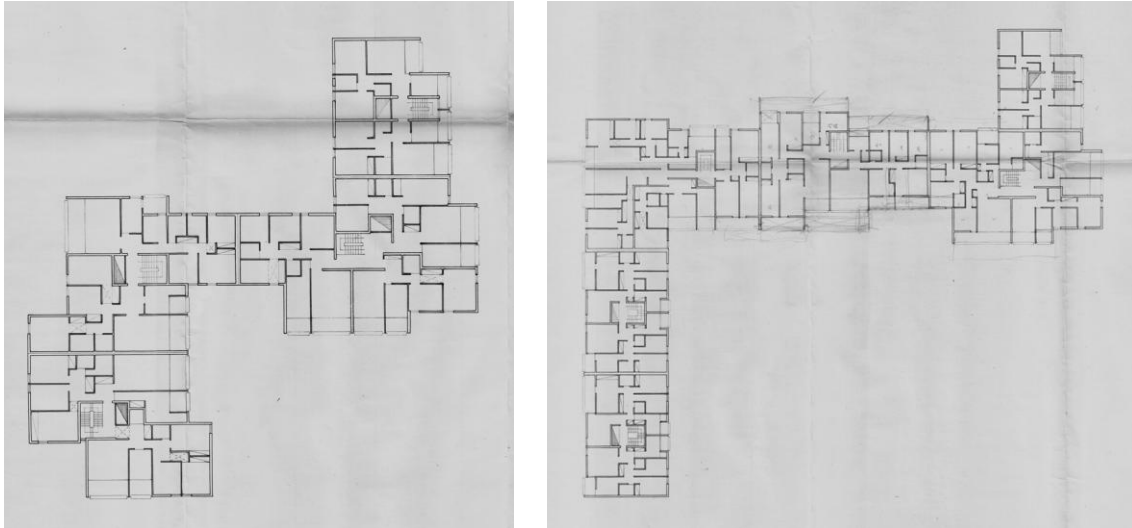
Plantas tipo, Luiz Carlos Silva Monteiro Cabral, s.d.⁸⁶⁰
